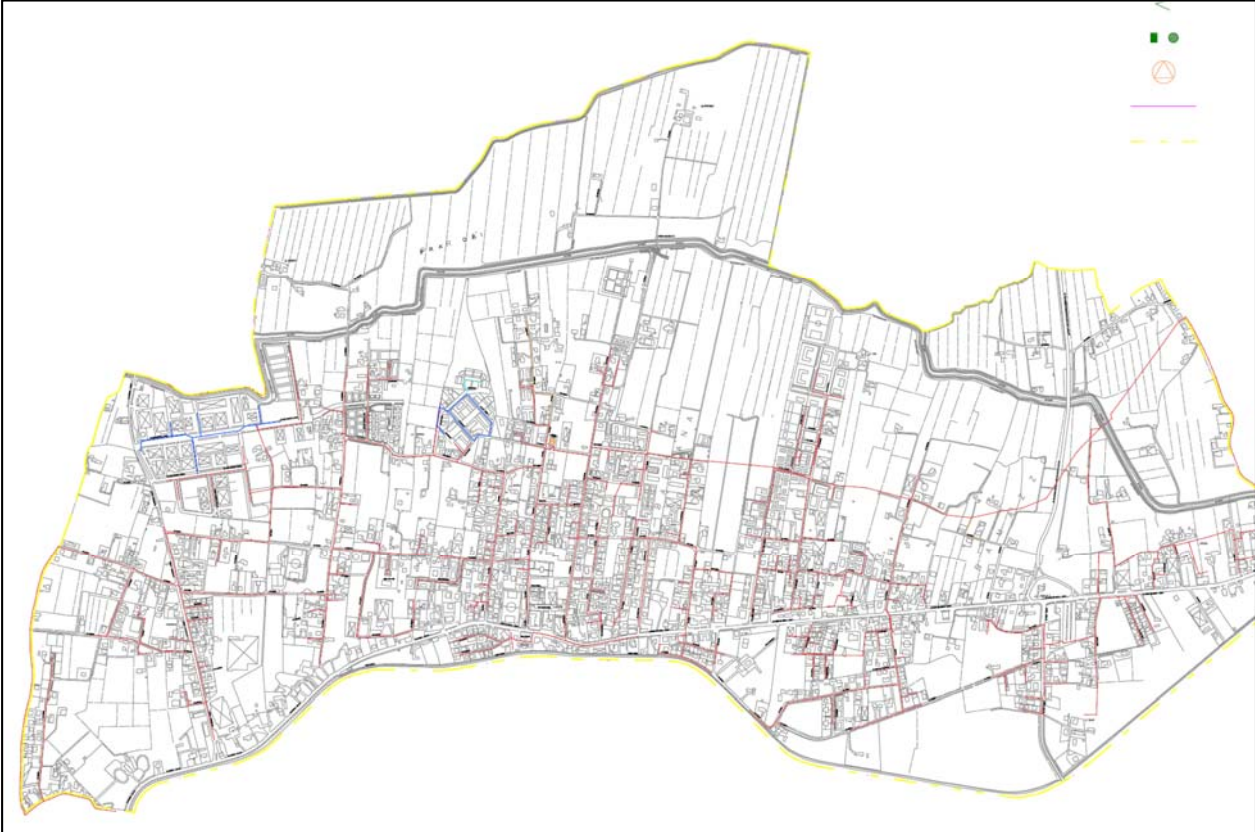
Planimetria della rete fognaria – Fonte VERITAS 2018
